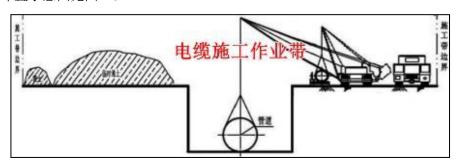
电缆线路沟槽、排管施工作业带施工布置示意图
